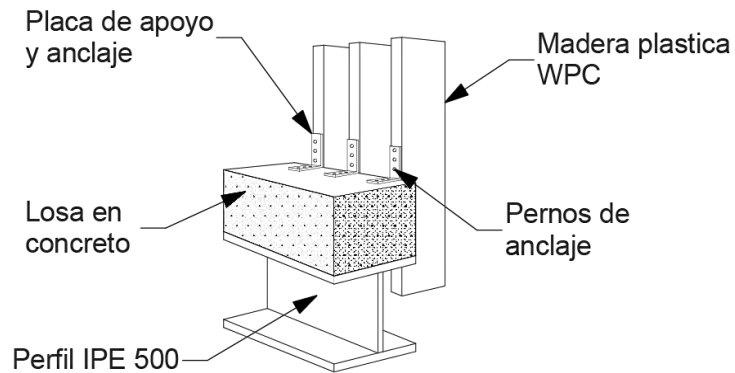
Detalle fachada auditorio Música. Fuente: Elaboración Propia.
